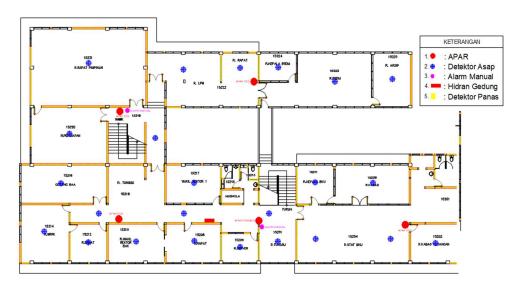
Hasil Perhitungan Pada Denah Gedung 14 Lantai 2
